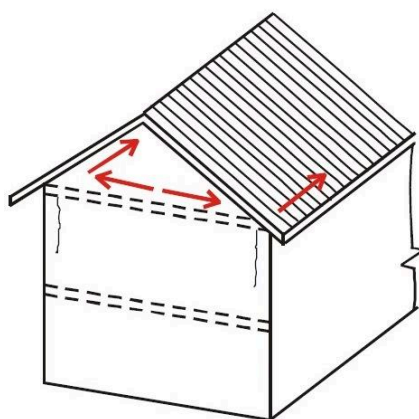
Fissuras verticais em paredes de alvenaria por retração da laje (DUARTE, 1998).
